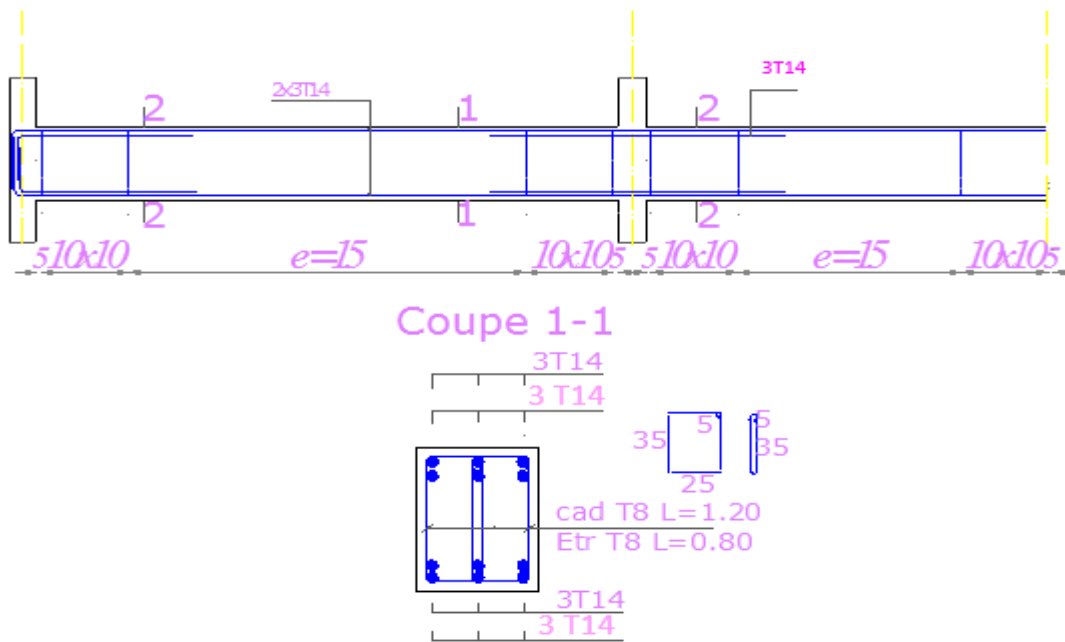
Schéma de ferrailage d'une poutre secondaire –la plus sollicitée–
